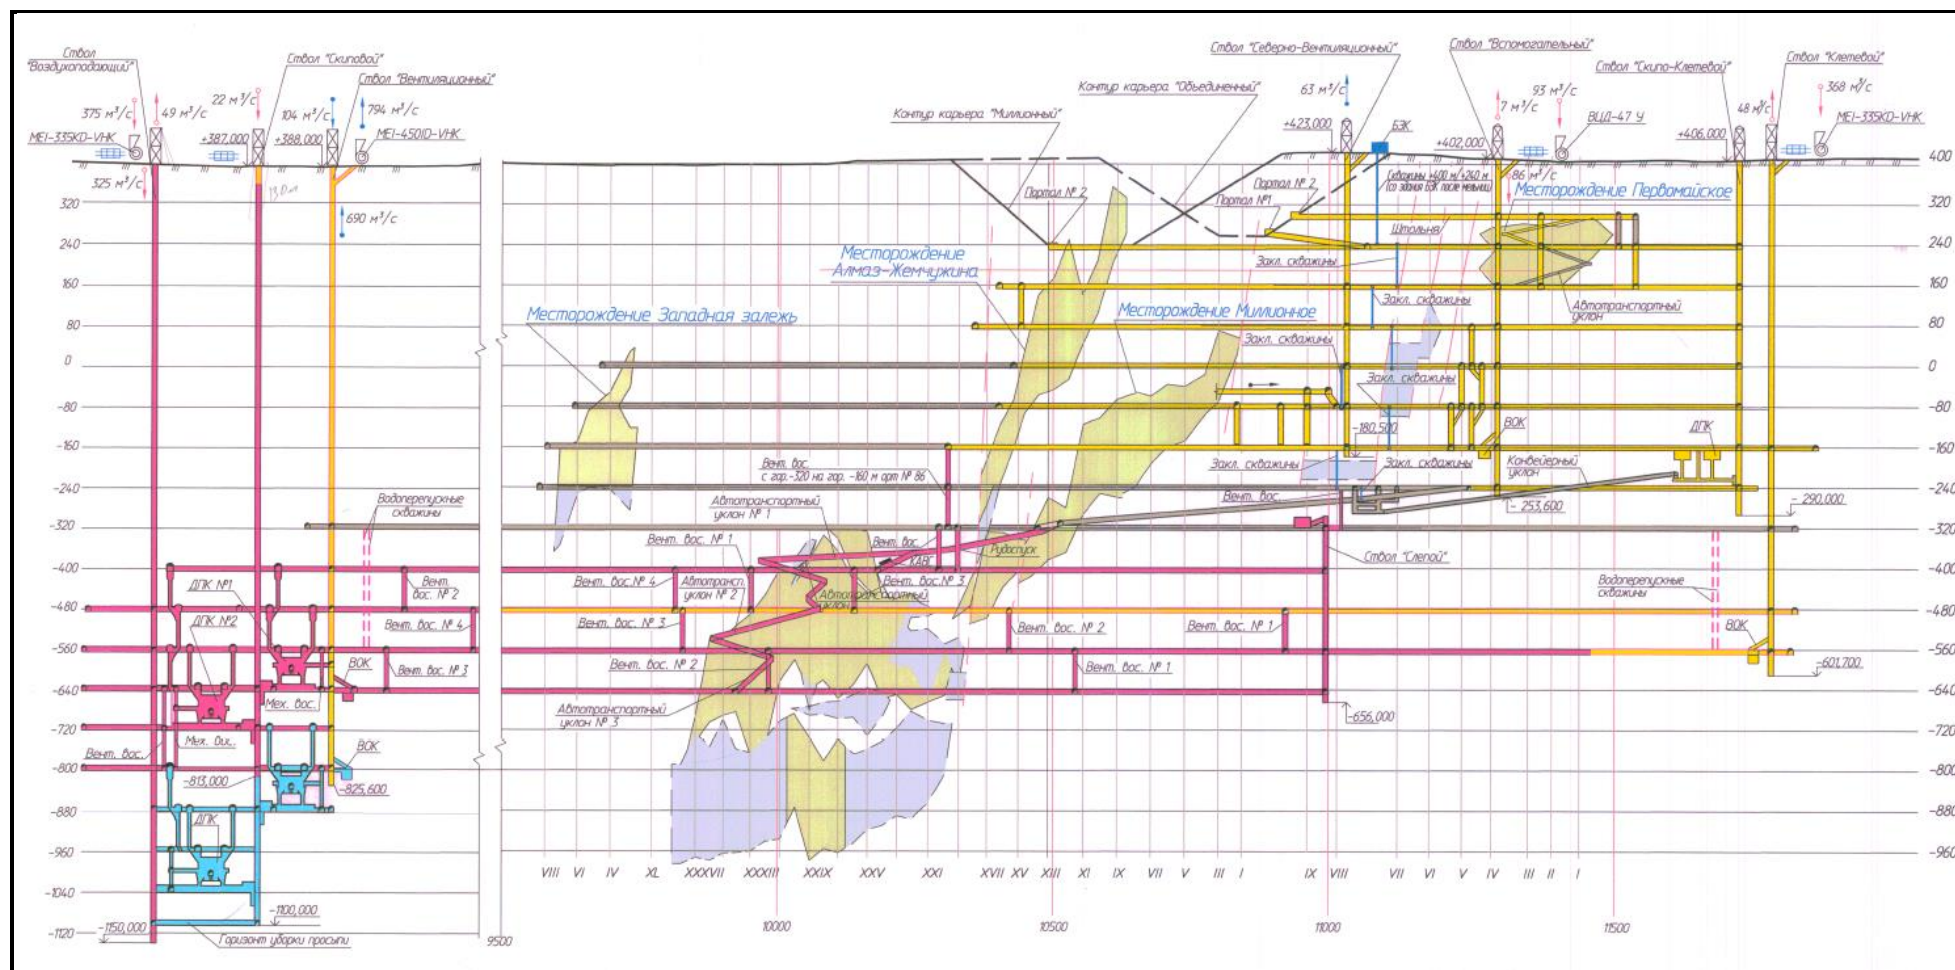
Схема вскрытия для шахты ДНК на этажах -480М/-640
